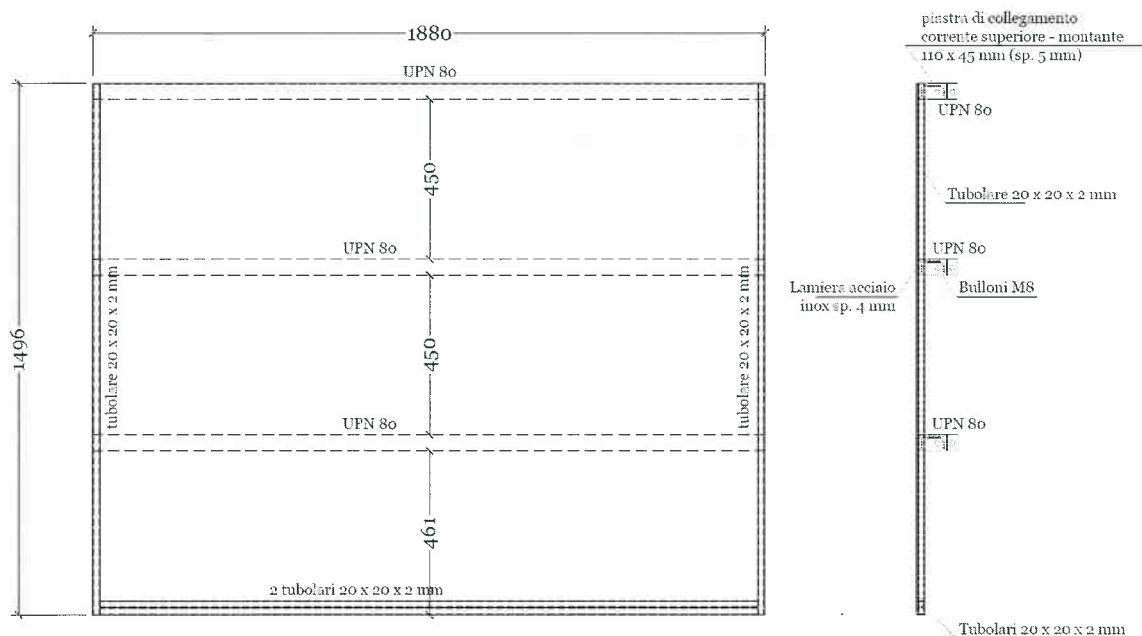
Vista in prospettiva e sezione dell'elemento costruttivo: parete laterale tipo 1
